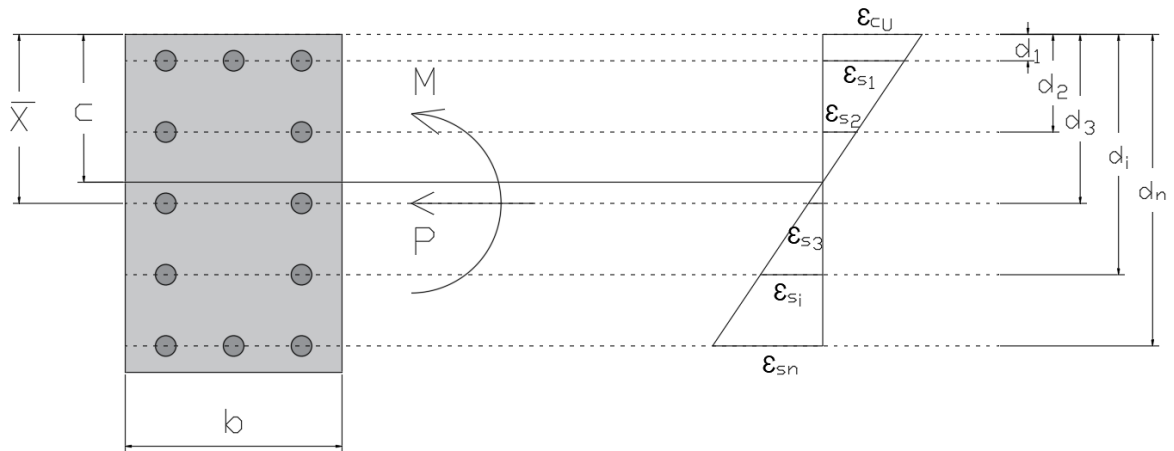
4: Deformaciones unitarias en una sección de hormigón armado
